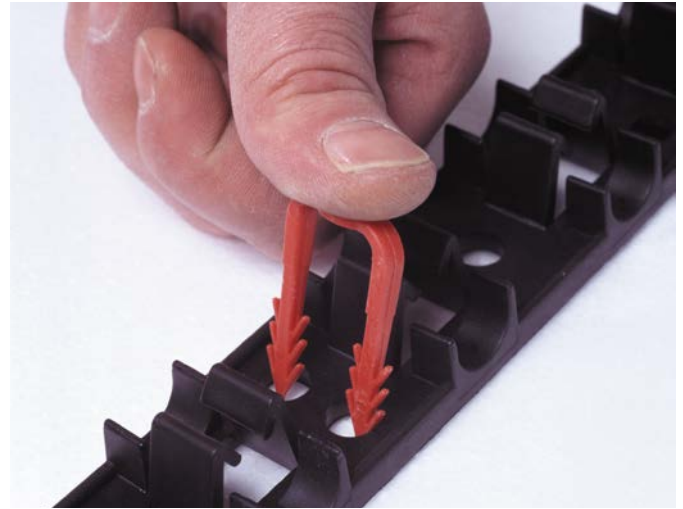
Haltenadel in Fußbodenaufbau drücken
